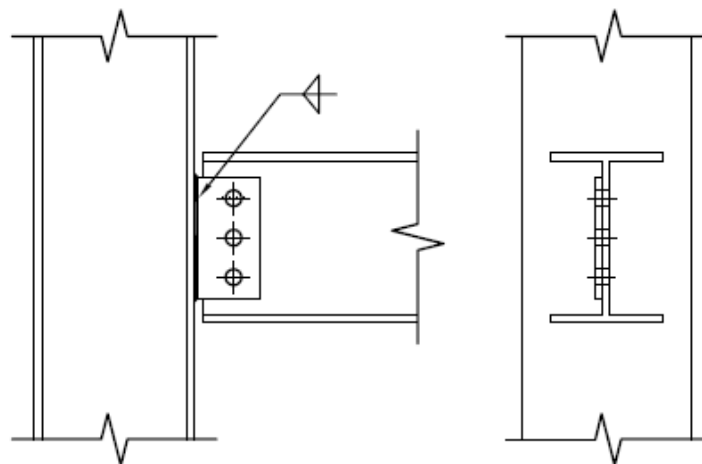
ligação semi-rígida com chapa simples (adaptado de MELLO, 1999)
